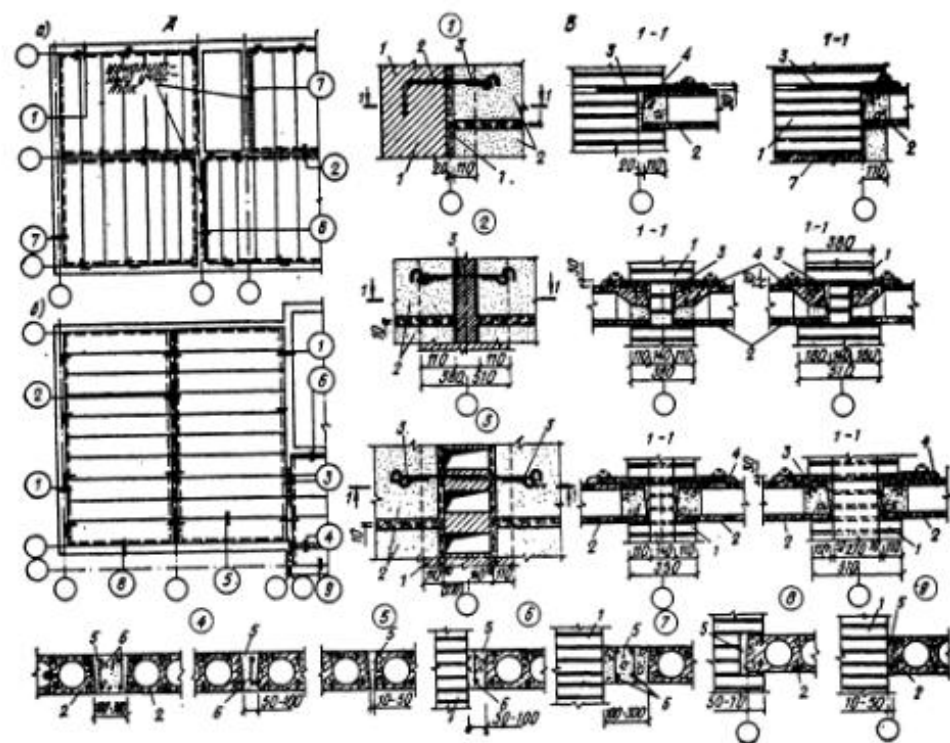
Конструктивные решения перекрытий из многопустотных настилов в зданиях с кирпичными стенами: А - монтажные схемы плана перекрытий в зданиях с несущими продольными (а) и поперечными (б) стенами; Б - конструктивные узлы; 1 - стена; 2 - настилы перекрытия; 3 - стальной анкер; 4 - цементно-песчаный раствор; 5 - бетон; 6 - арматурный каркас
